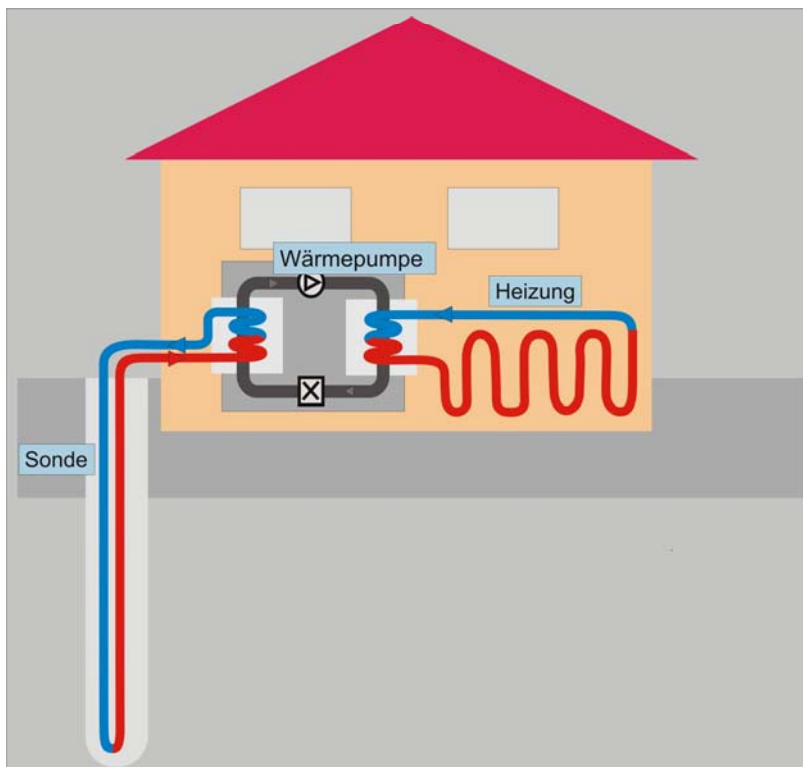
Funktionsschema - Anlagen mit Erdwärmesonden
